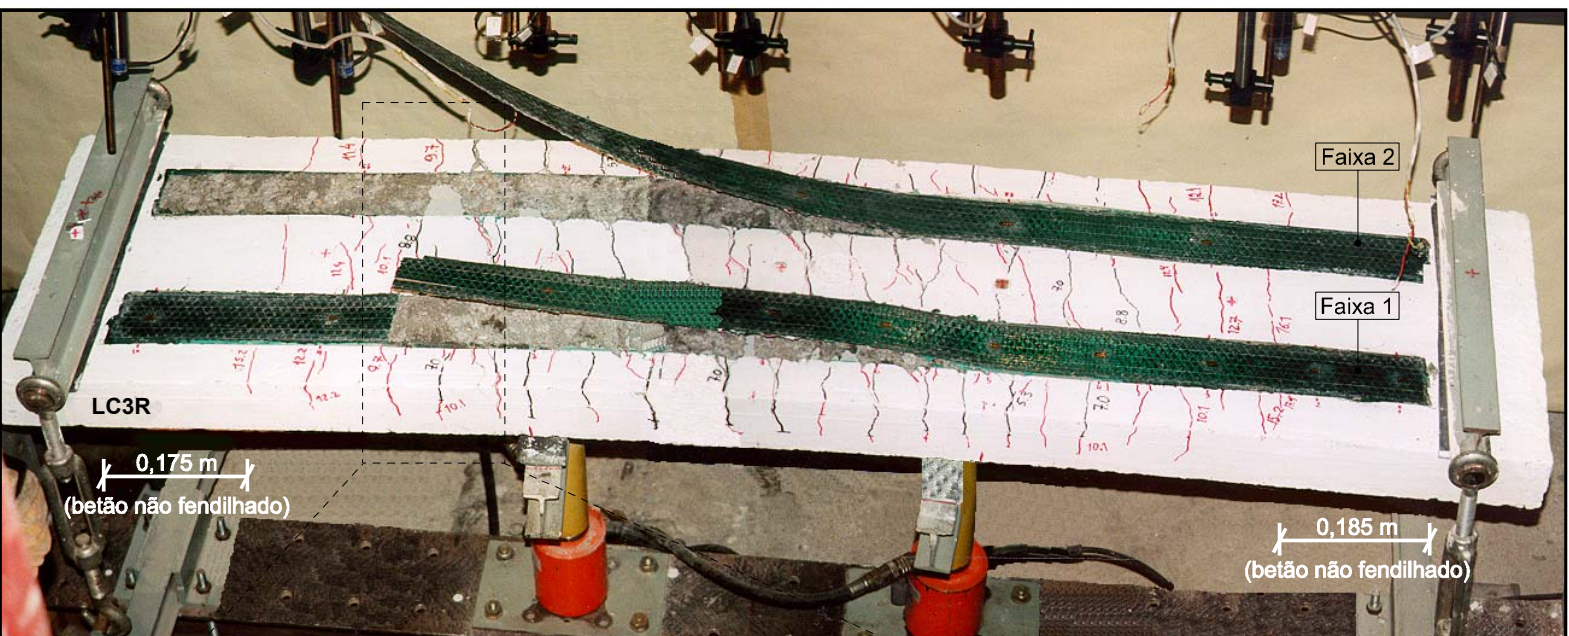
Aspecto geral da laje LC3R após o ensaio (vista e pormenor).
